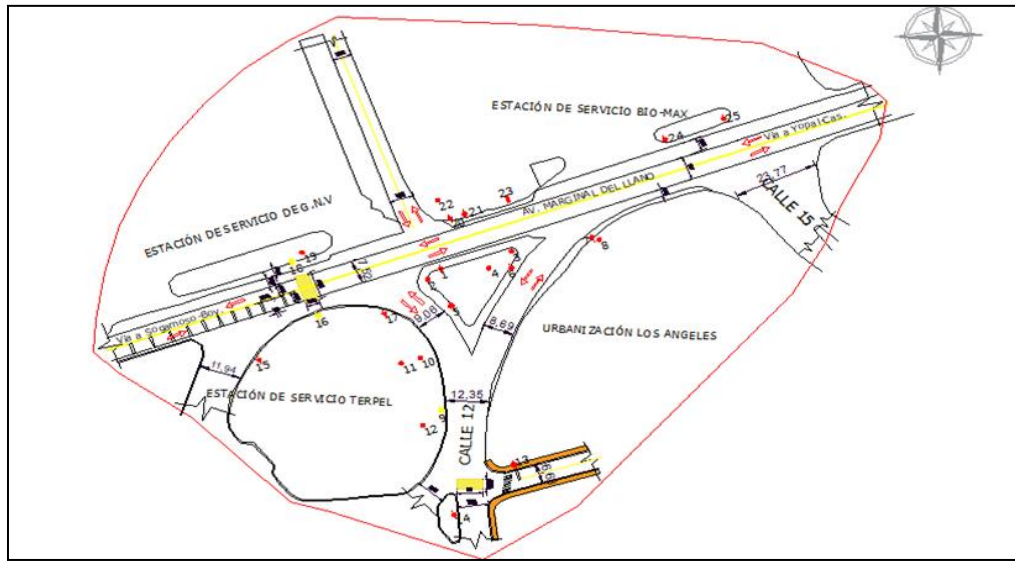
Plano intersección Calle 12 con Av. Marginal del llano.
